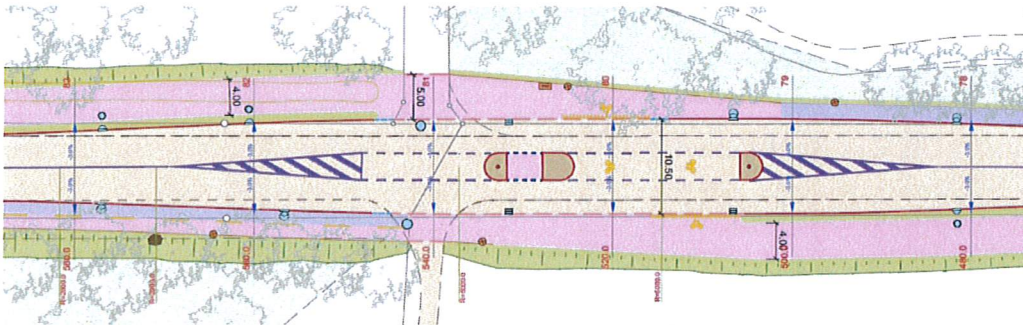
Extrait du plan des aménagements: aménagement de la traversée de la voie verte sur le secteur du chemin du Boiron à Lully
